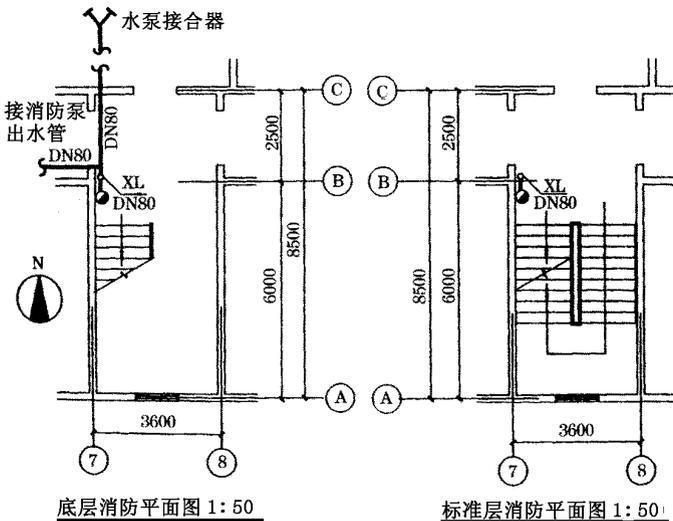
底层消防平面图 图 13-1-13 二~九层消防平面图
